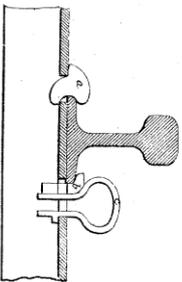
Coupe d'un rail longirine (1/4 de déca°)
